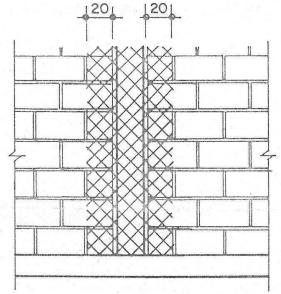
Recuperação de destacamento pilar/parede com tela de metal
